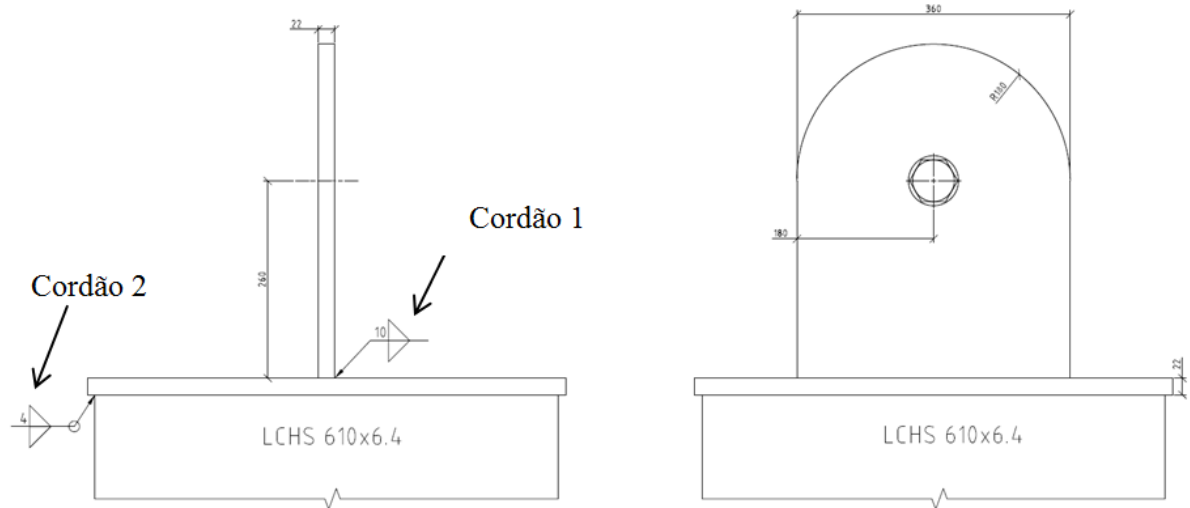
Identificação dos cordões de soldadura (diagonal do contraventamento)
